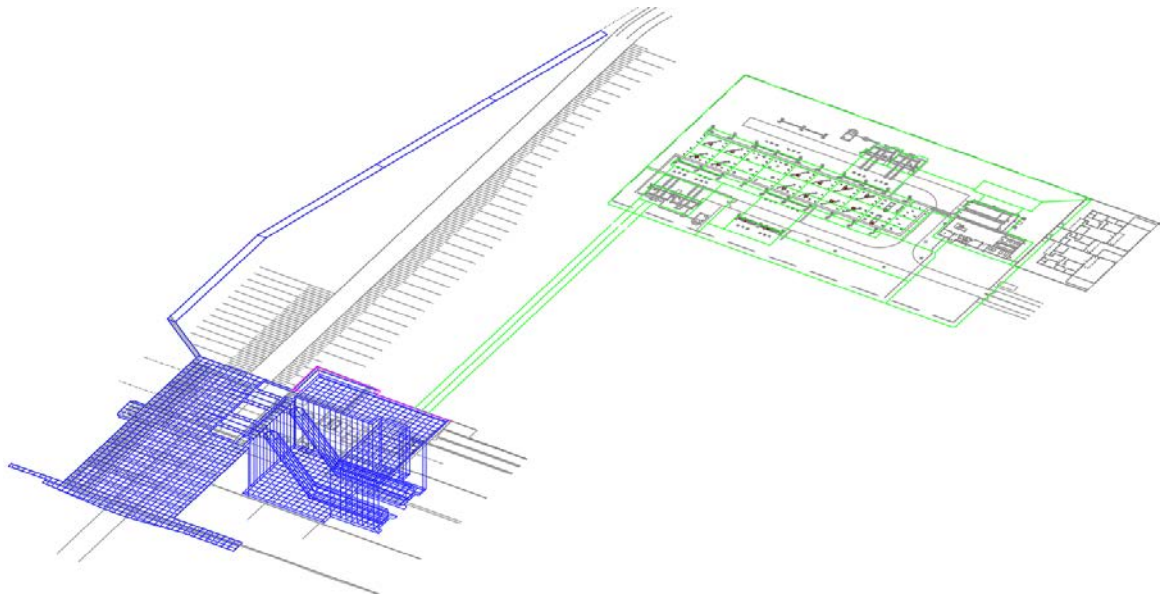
Layout impianto di terra con cavi di collegamento tranciati – Vista 3D
